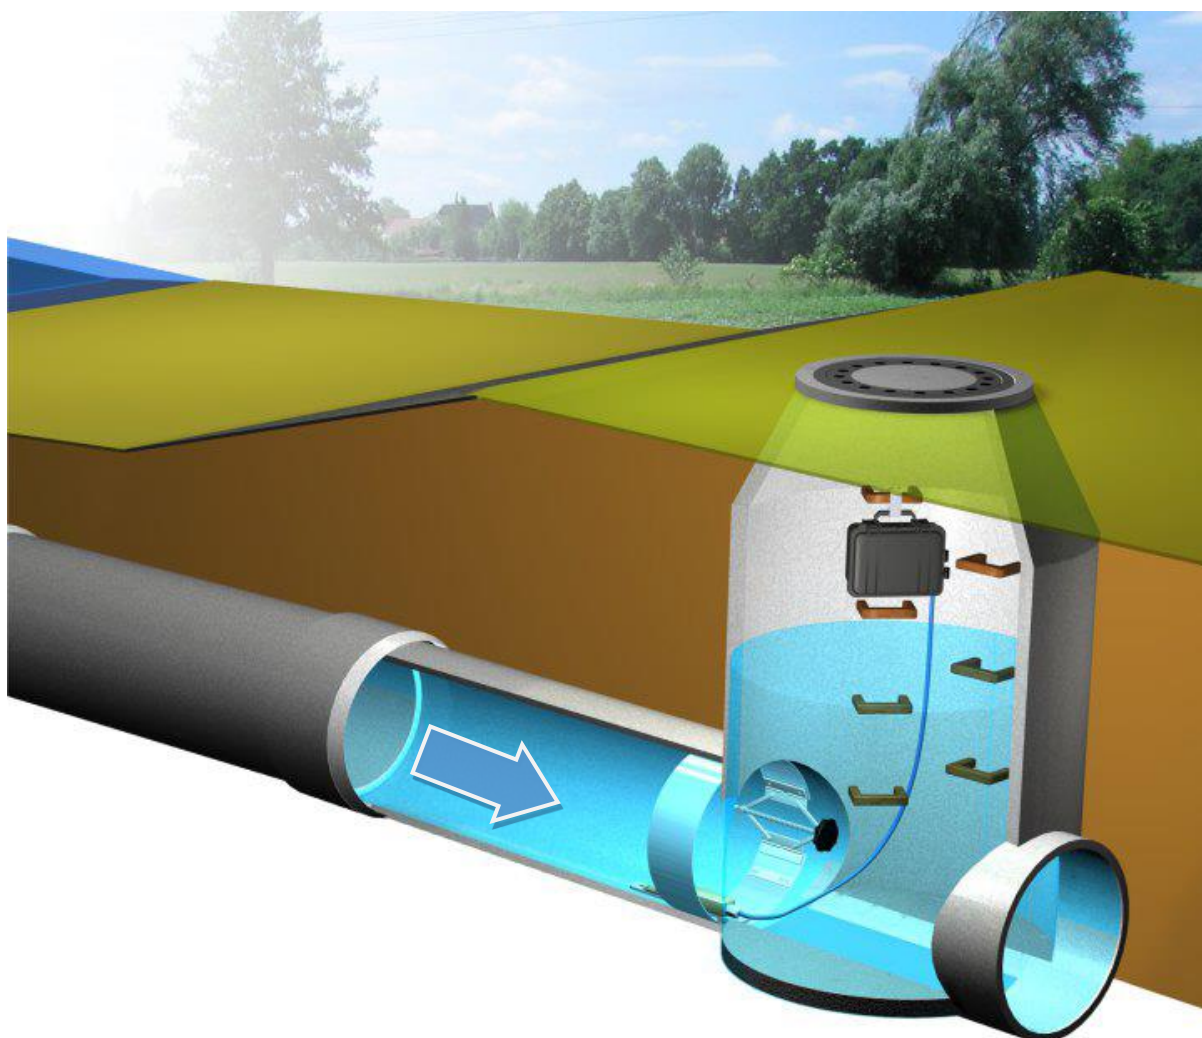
Schema tipo d'installazione della strumentazione con sonda ubicata sul fondo della condotta.
